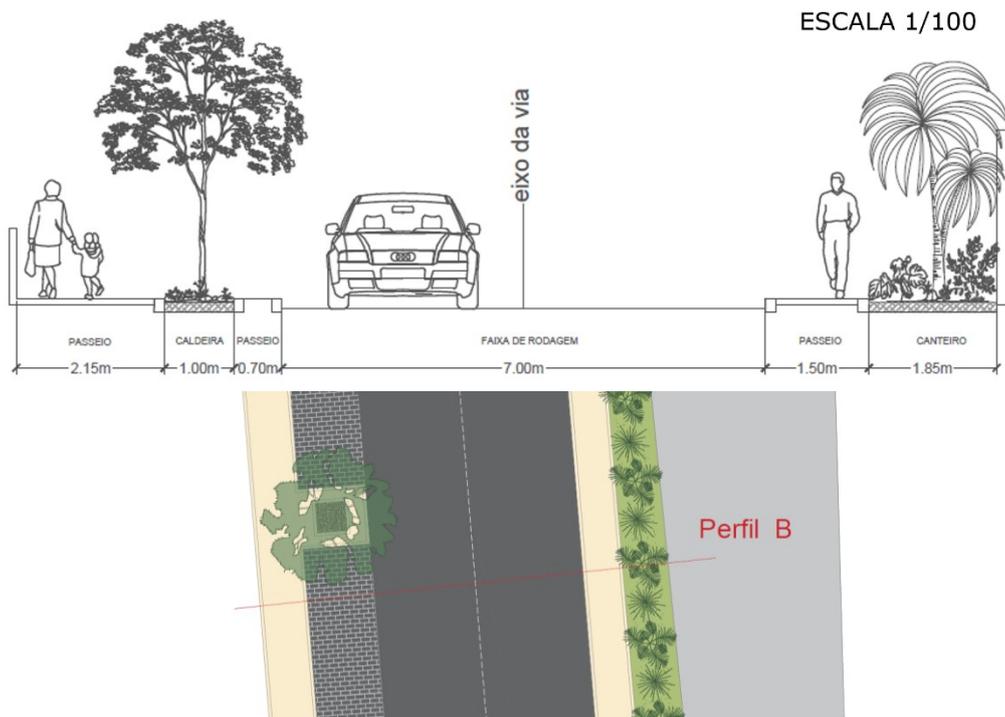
Perfil proposto para a Rua Joaquim Aleixo (zona sul) – Perfil B
